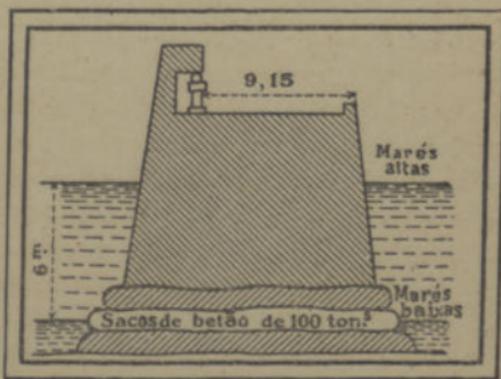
Molhe de Newhaven. Tipo de molhe construído sôbre sacos de betão de cimento.
